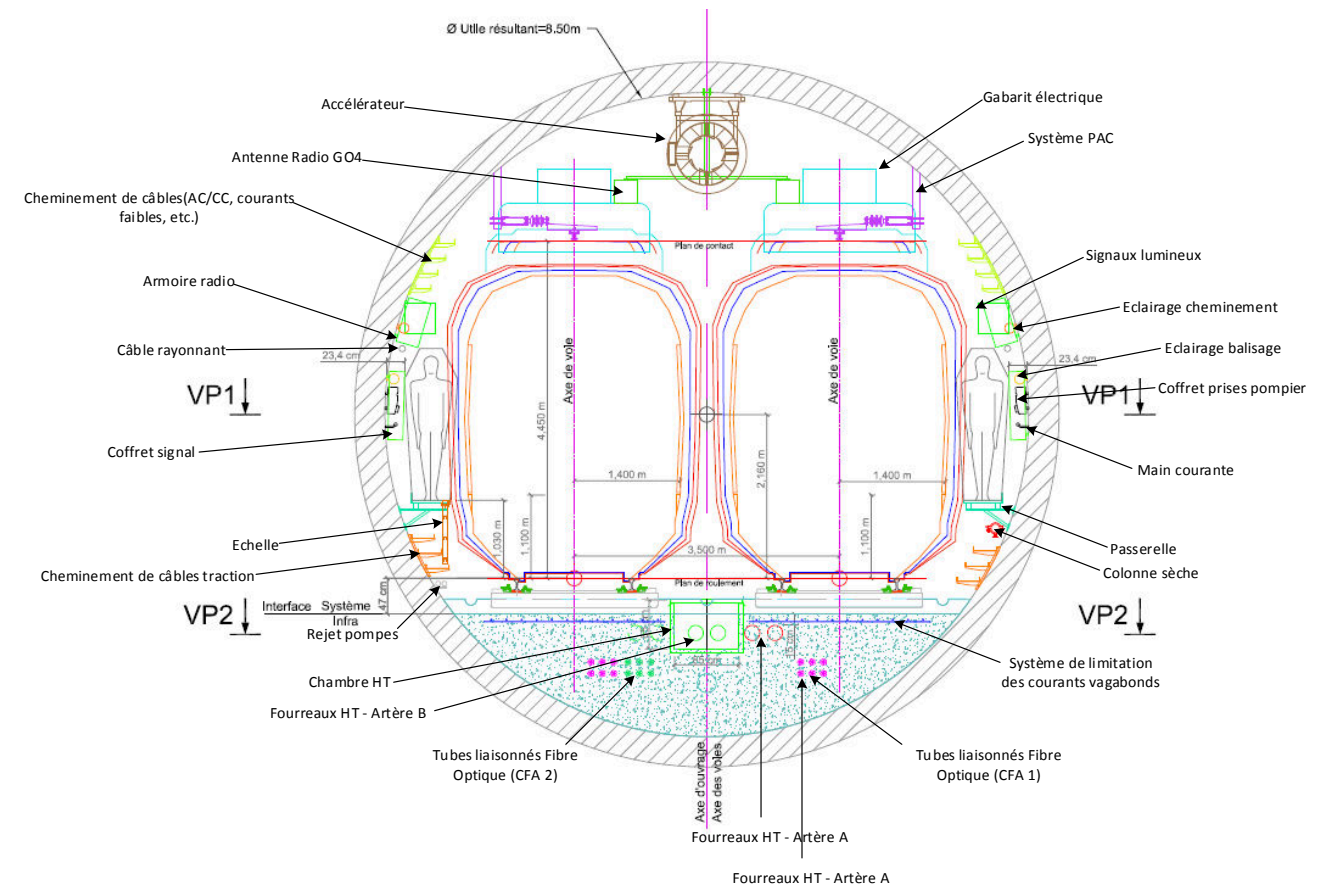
Coupe type tunnel monotube ligne 17 Nord
